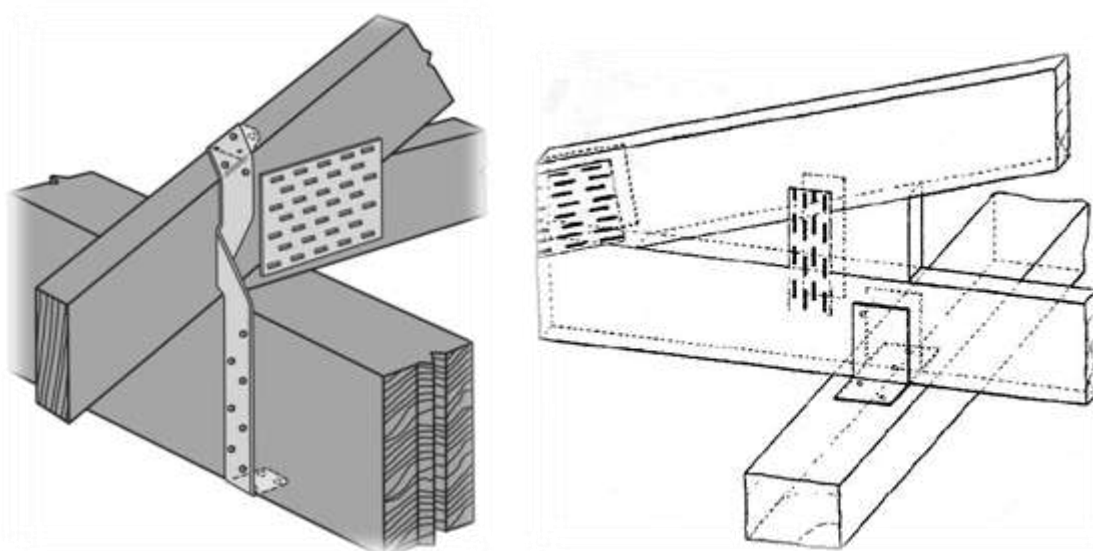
Pormenor de ligação da cobertura á parede resistente (SIMPSON, 2010) e (Mesquita Madeiras, 2004)
